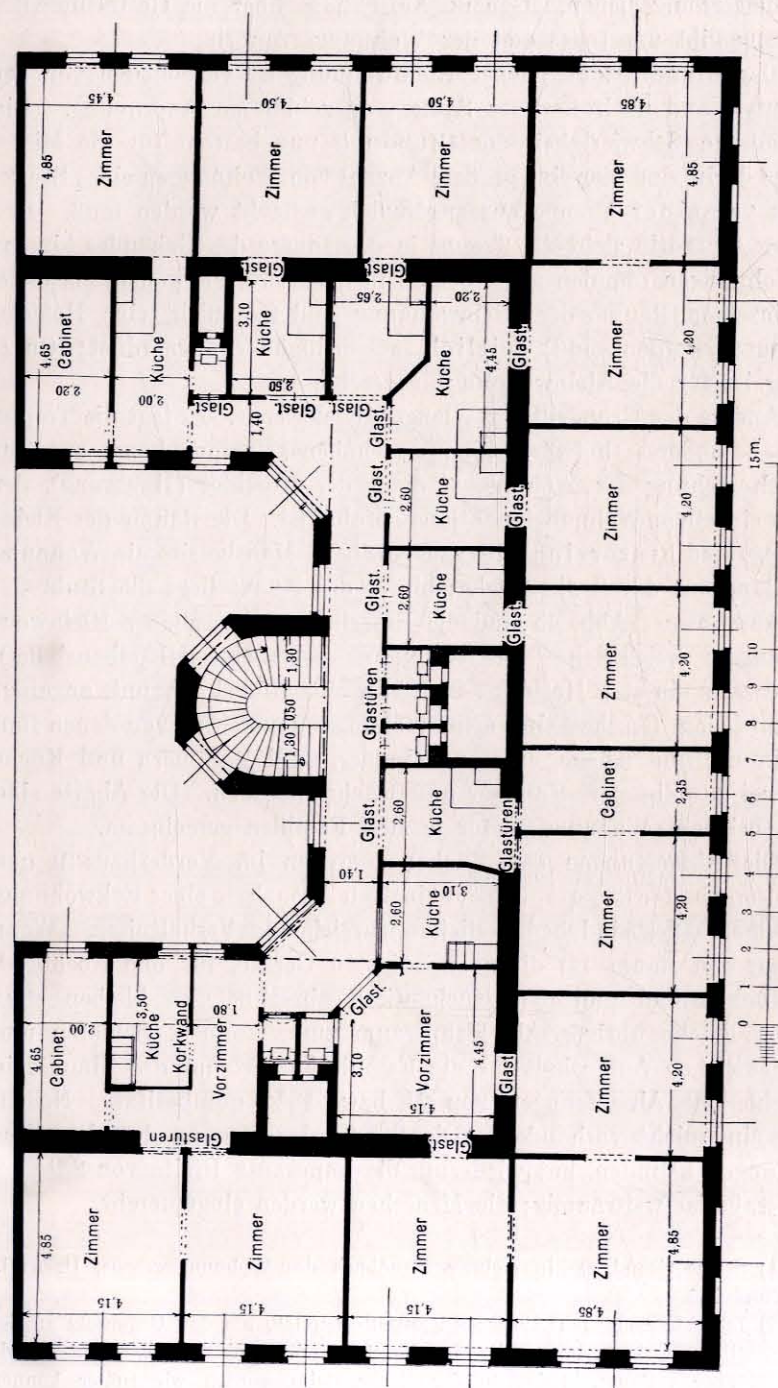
Neueres Wohngebäude, Eckbaustelle, Wien. Obergeschoß.
